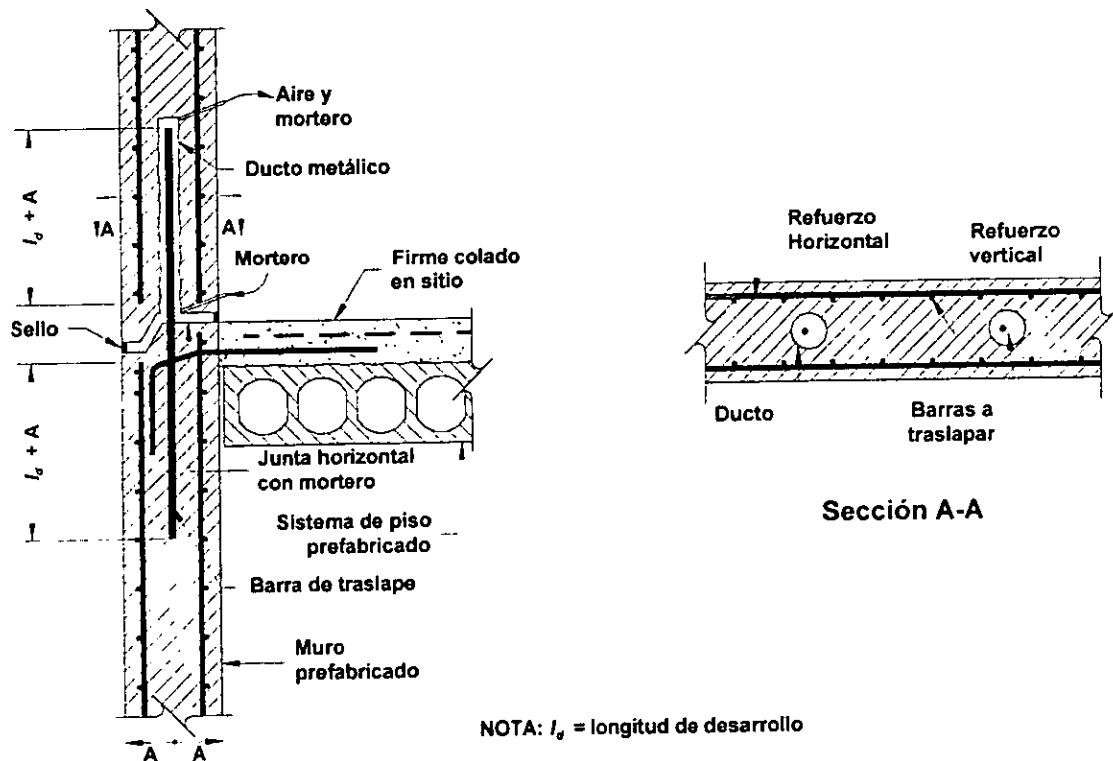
Conexión horizontal para muro prefabricado [Guidelines, 1991]
